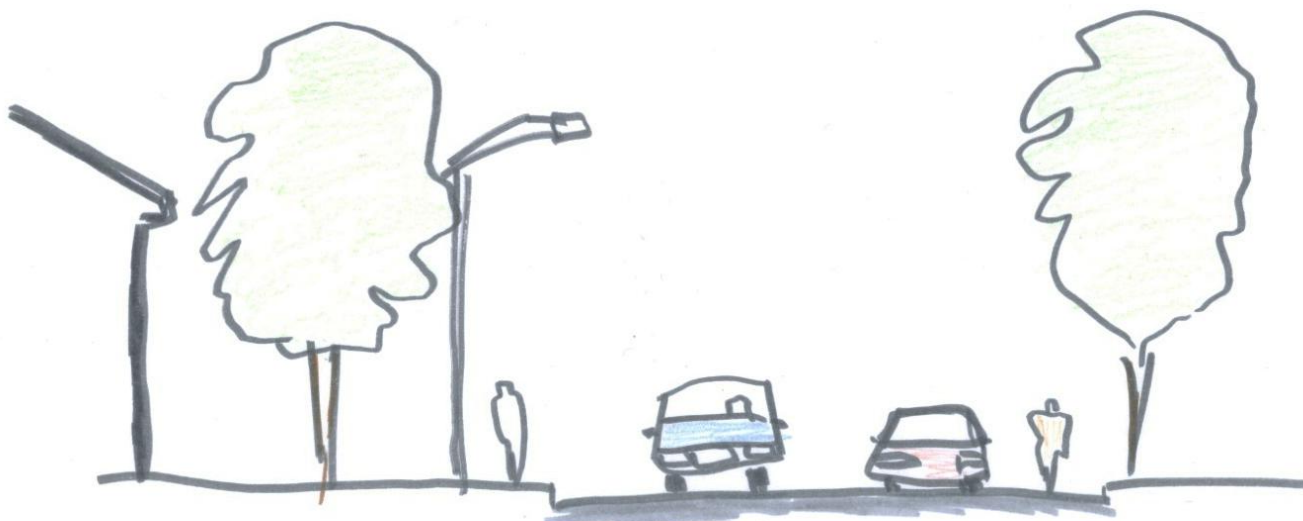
COUPE TRANSVERSALE DE L'AVENUE DE LA VERPILLIERE
